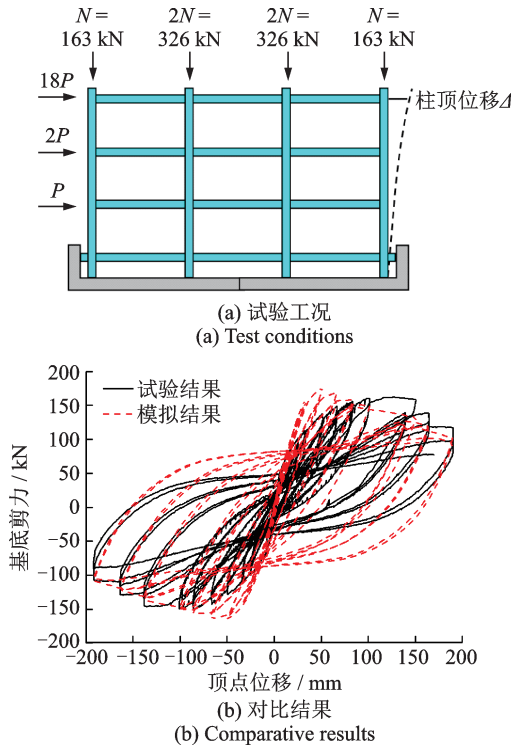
钢筋混凝土柱试验<sup>[24]</sup>
